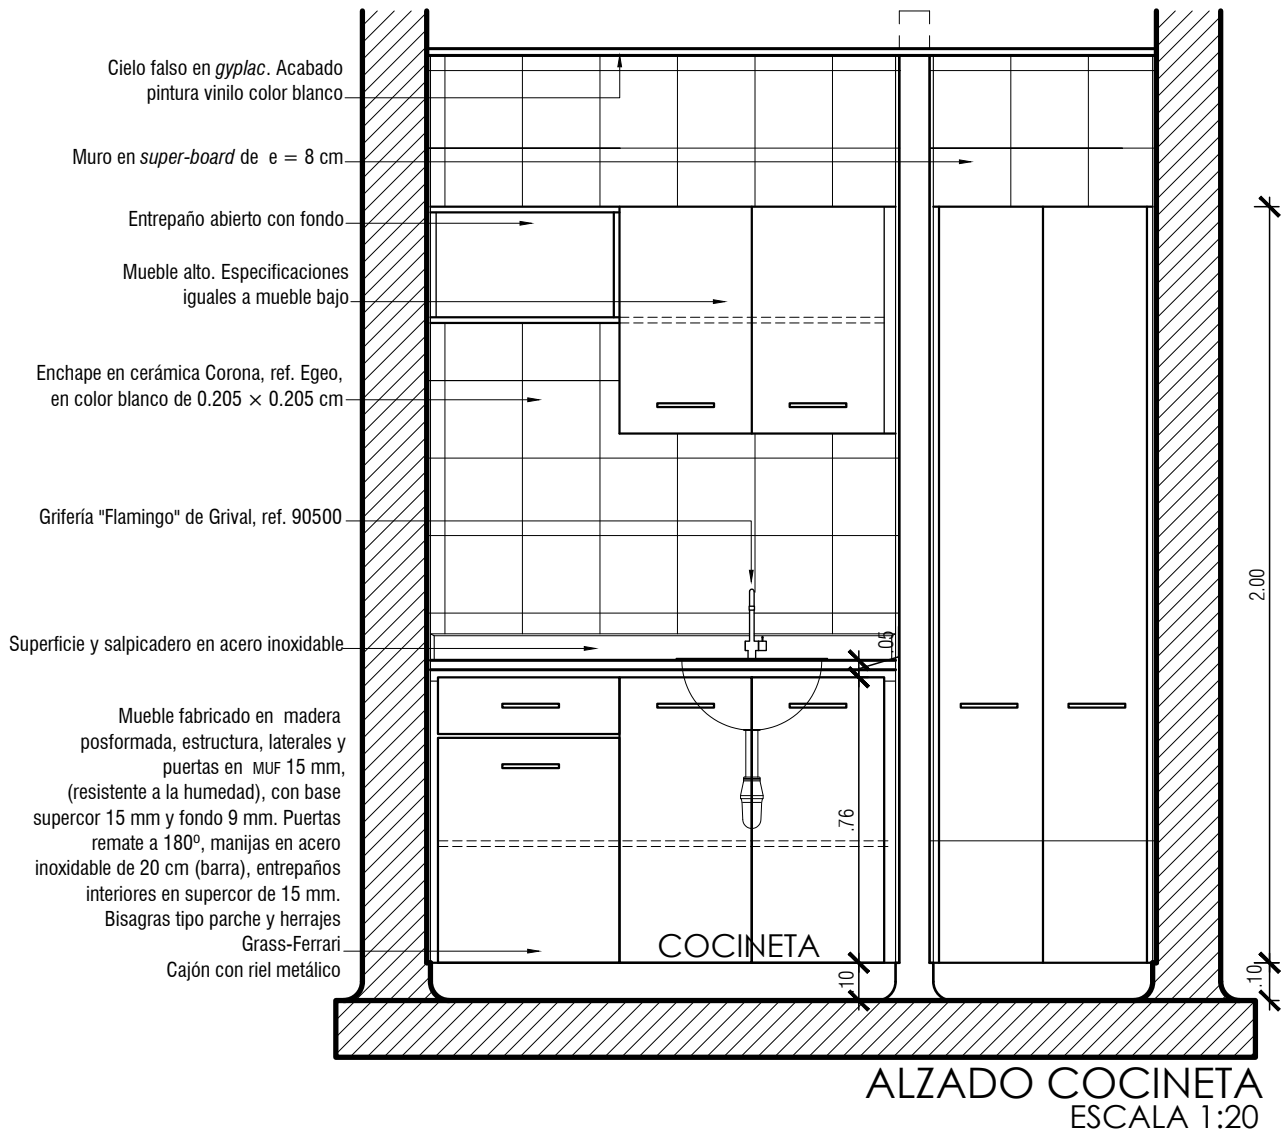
Representación de detalle en planta y alzado de mueble cocineta
